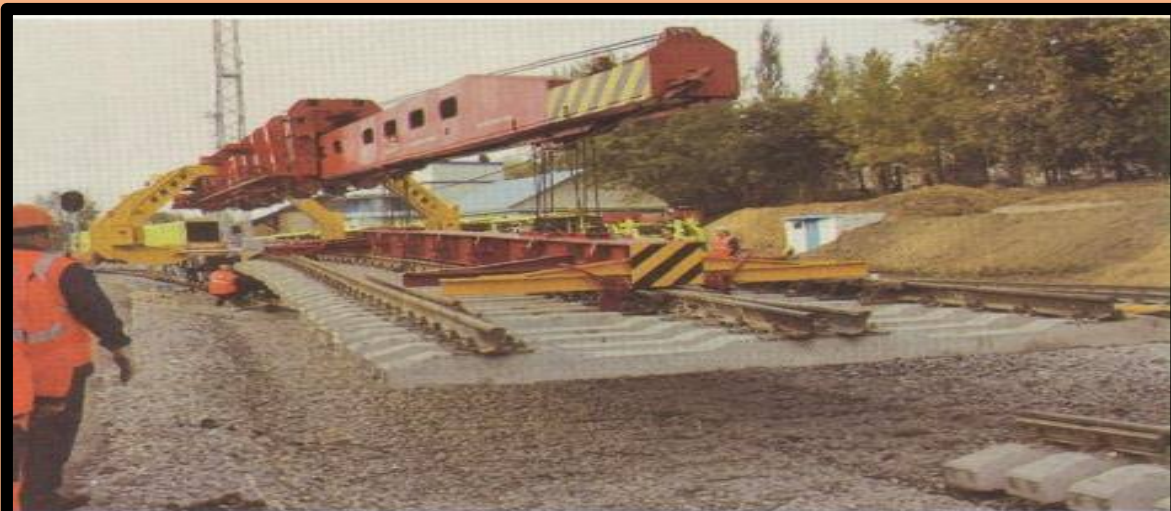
Замена стрелочного перевода на железобетонных брусьях с применением крана УК-25/28СП
